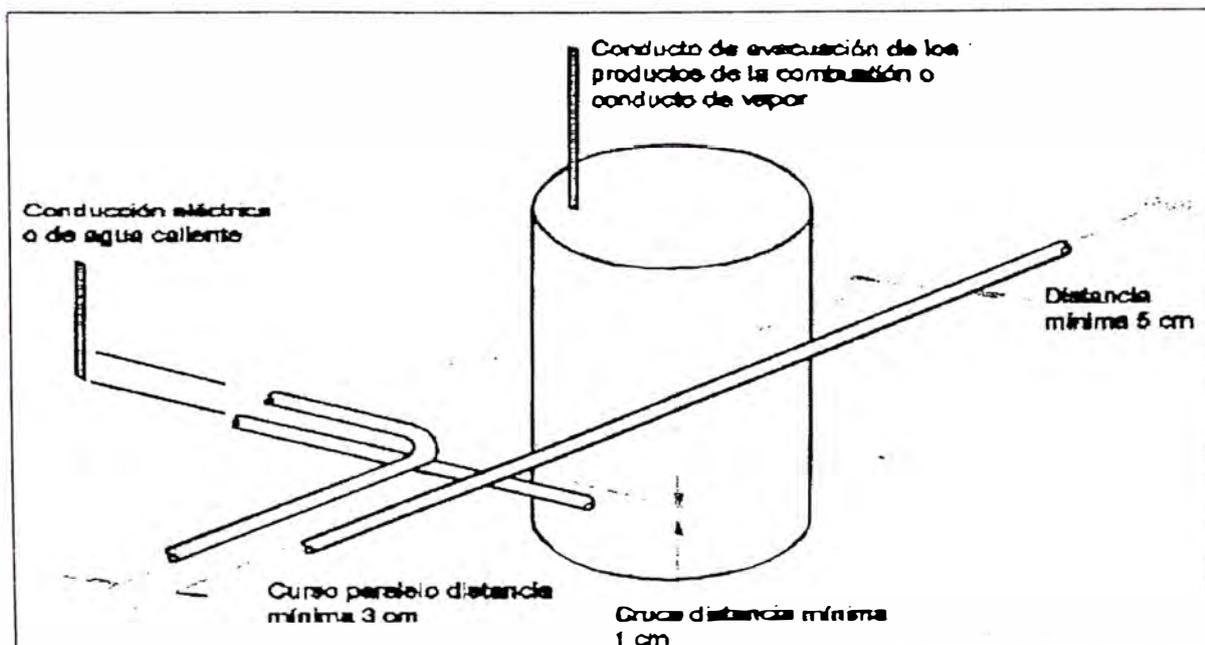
Tuberías que conducen gas instaladas a la vista o embebidas y tubería de otros servicios
